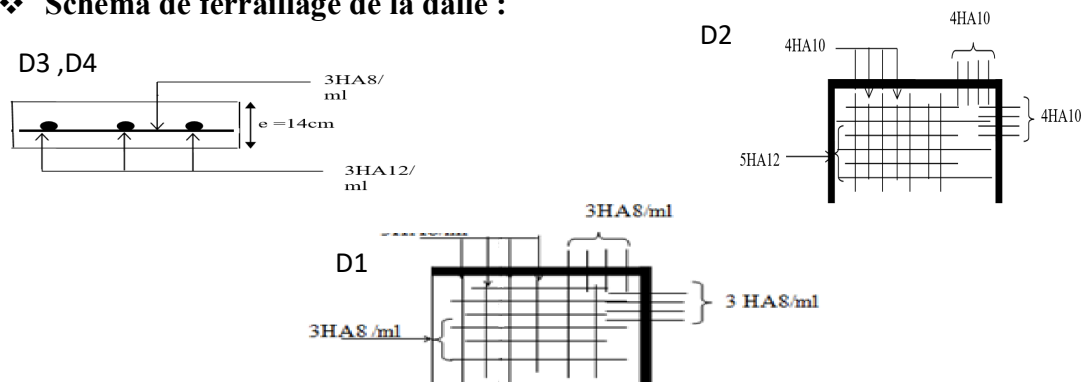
schéma de ferrailage des dalle D₁ D₂ D₃ et D₄
